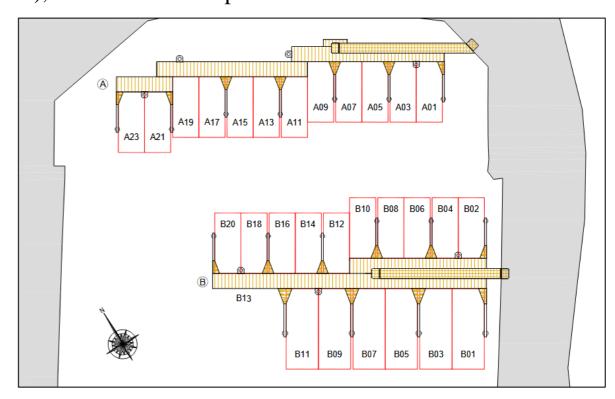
Esquema del puerto actual. Fuente: Puertos de Cantabria
